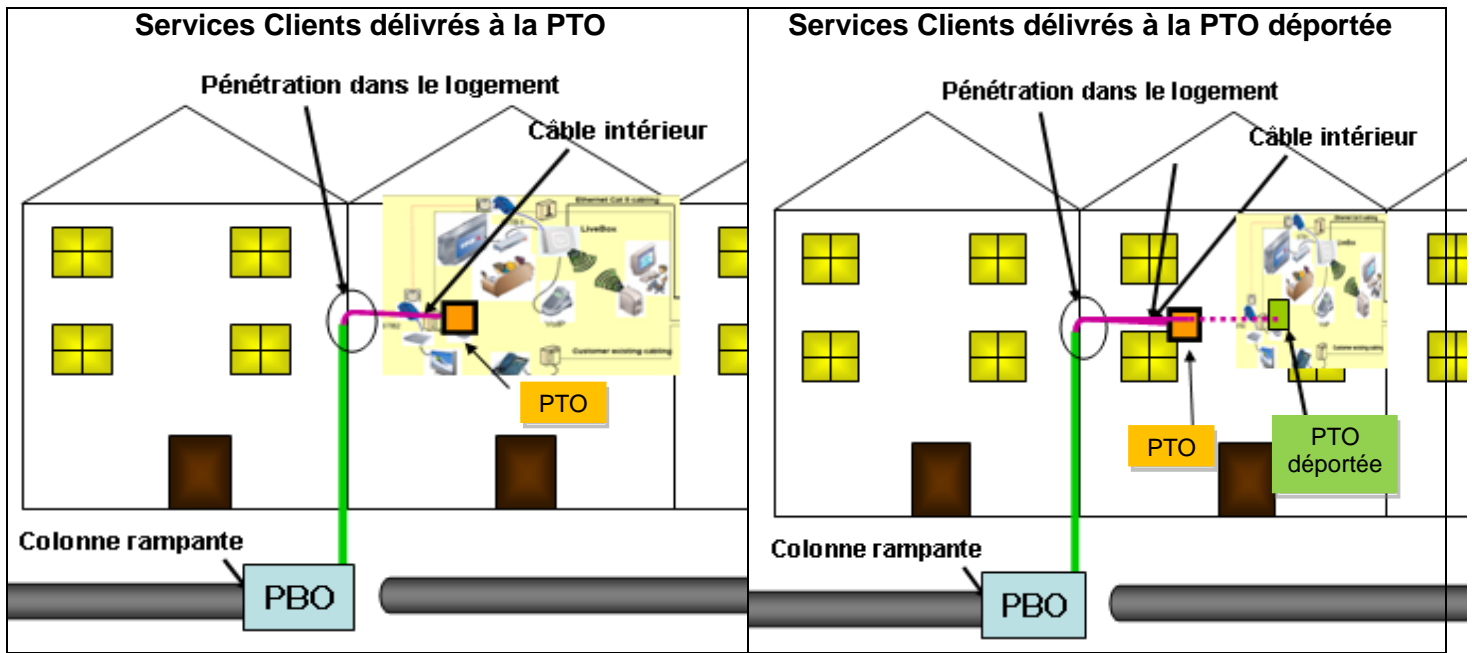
Schéma de principe du branchement du PB à la PTO en façade
